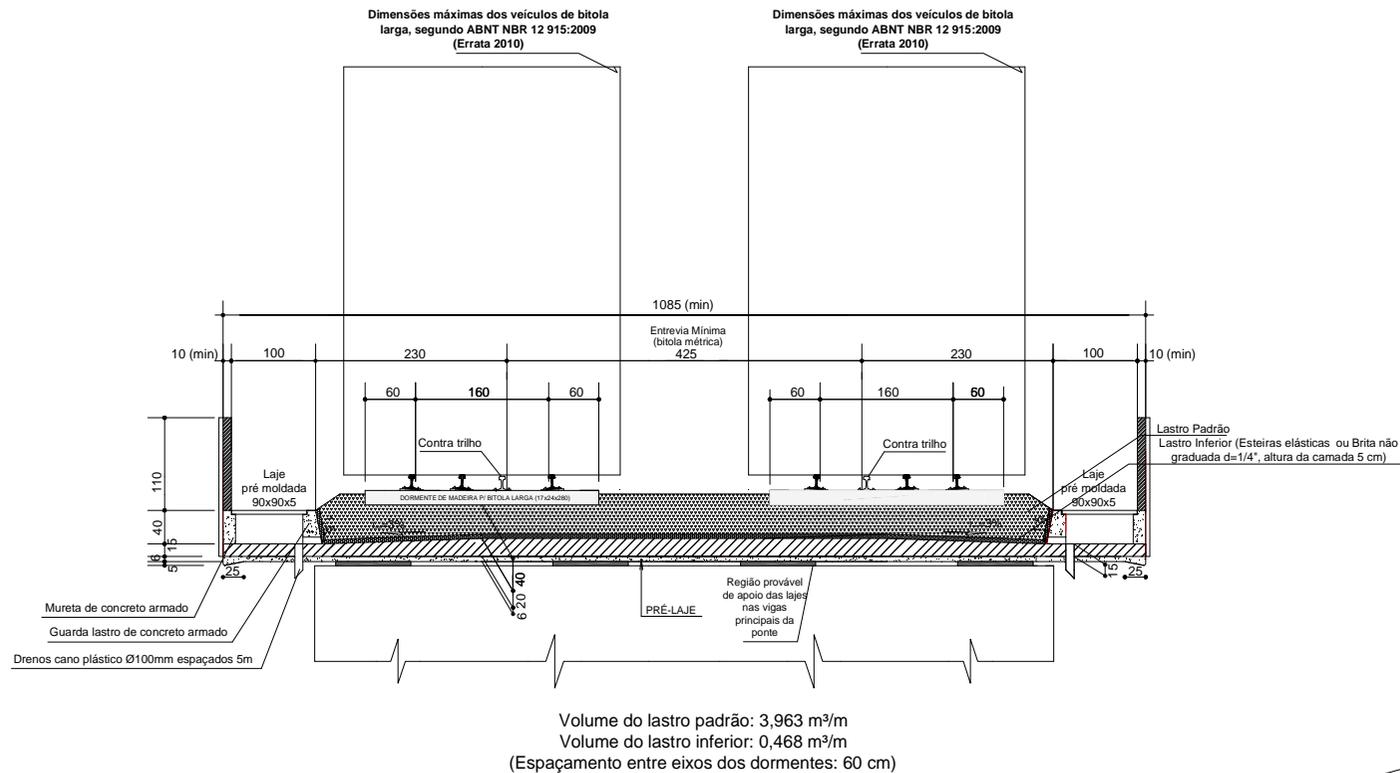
Gabarito de ponte em tangente, linha dupla – bitola mista (configuração da superestrutura da OAE e da via permanente com dormentes monoblocos ou biblocos de concreto armado ou protendido em linhas novas para trens tipo até
